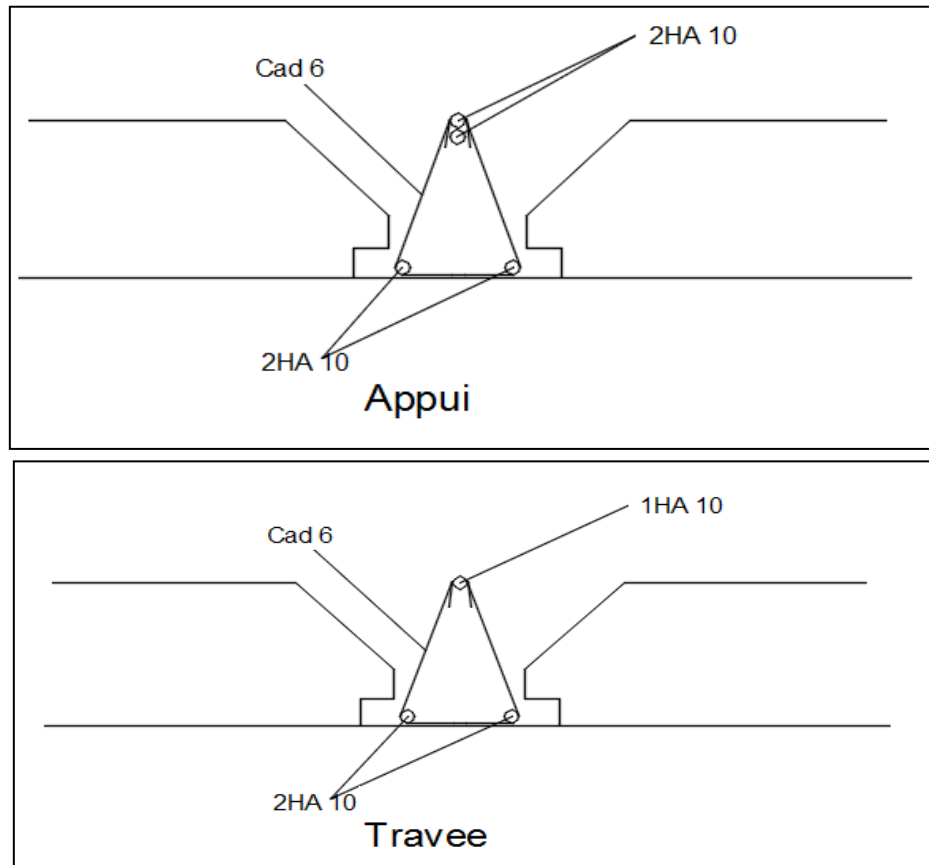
Coupe de ferrailage d'une poutrelle.
